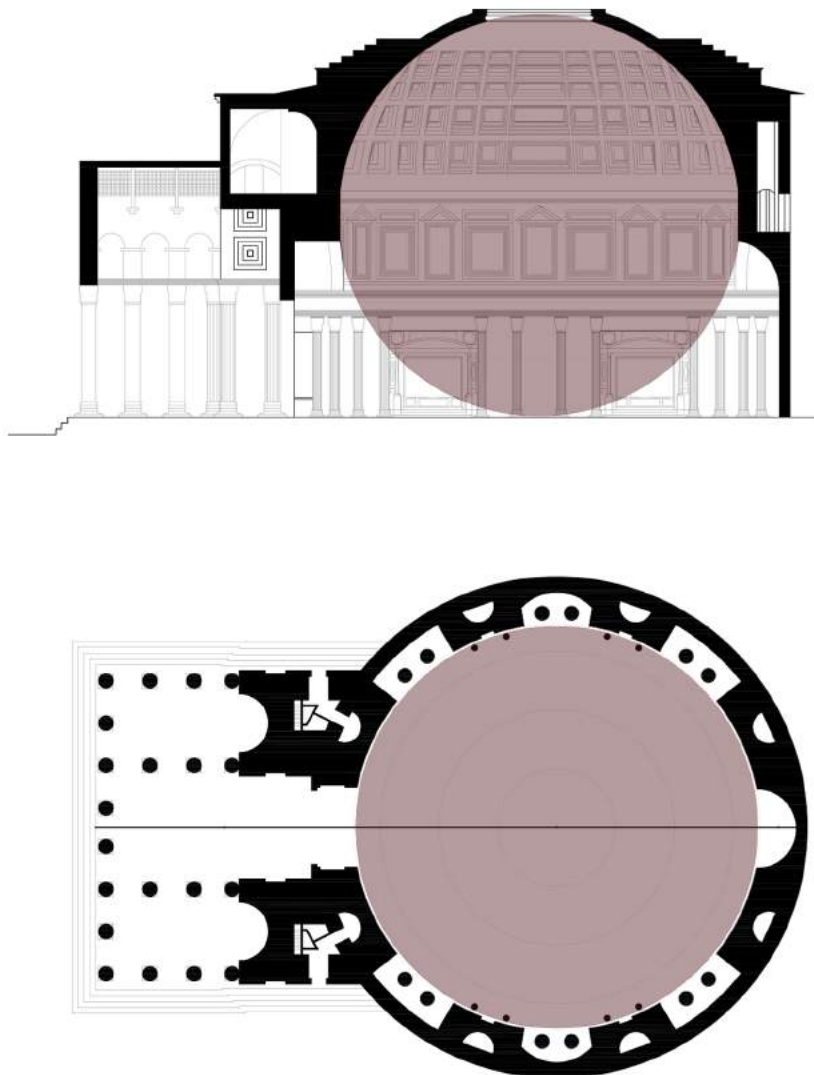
Planimetría del Panteón de Roma. Elaboración propia.
